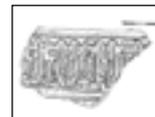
Plano de planta de la mezquita del Cortijo del Centeno.
